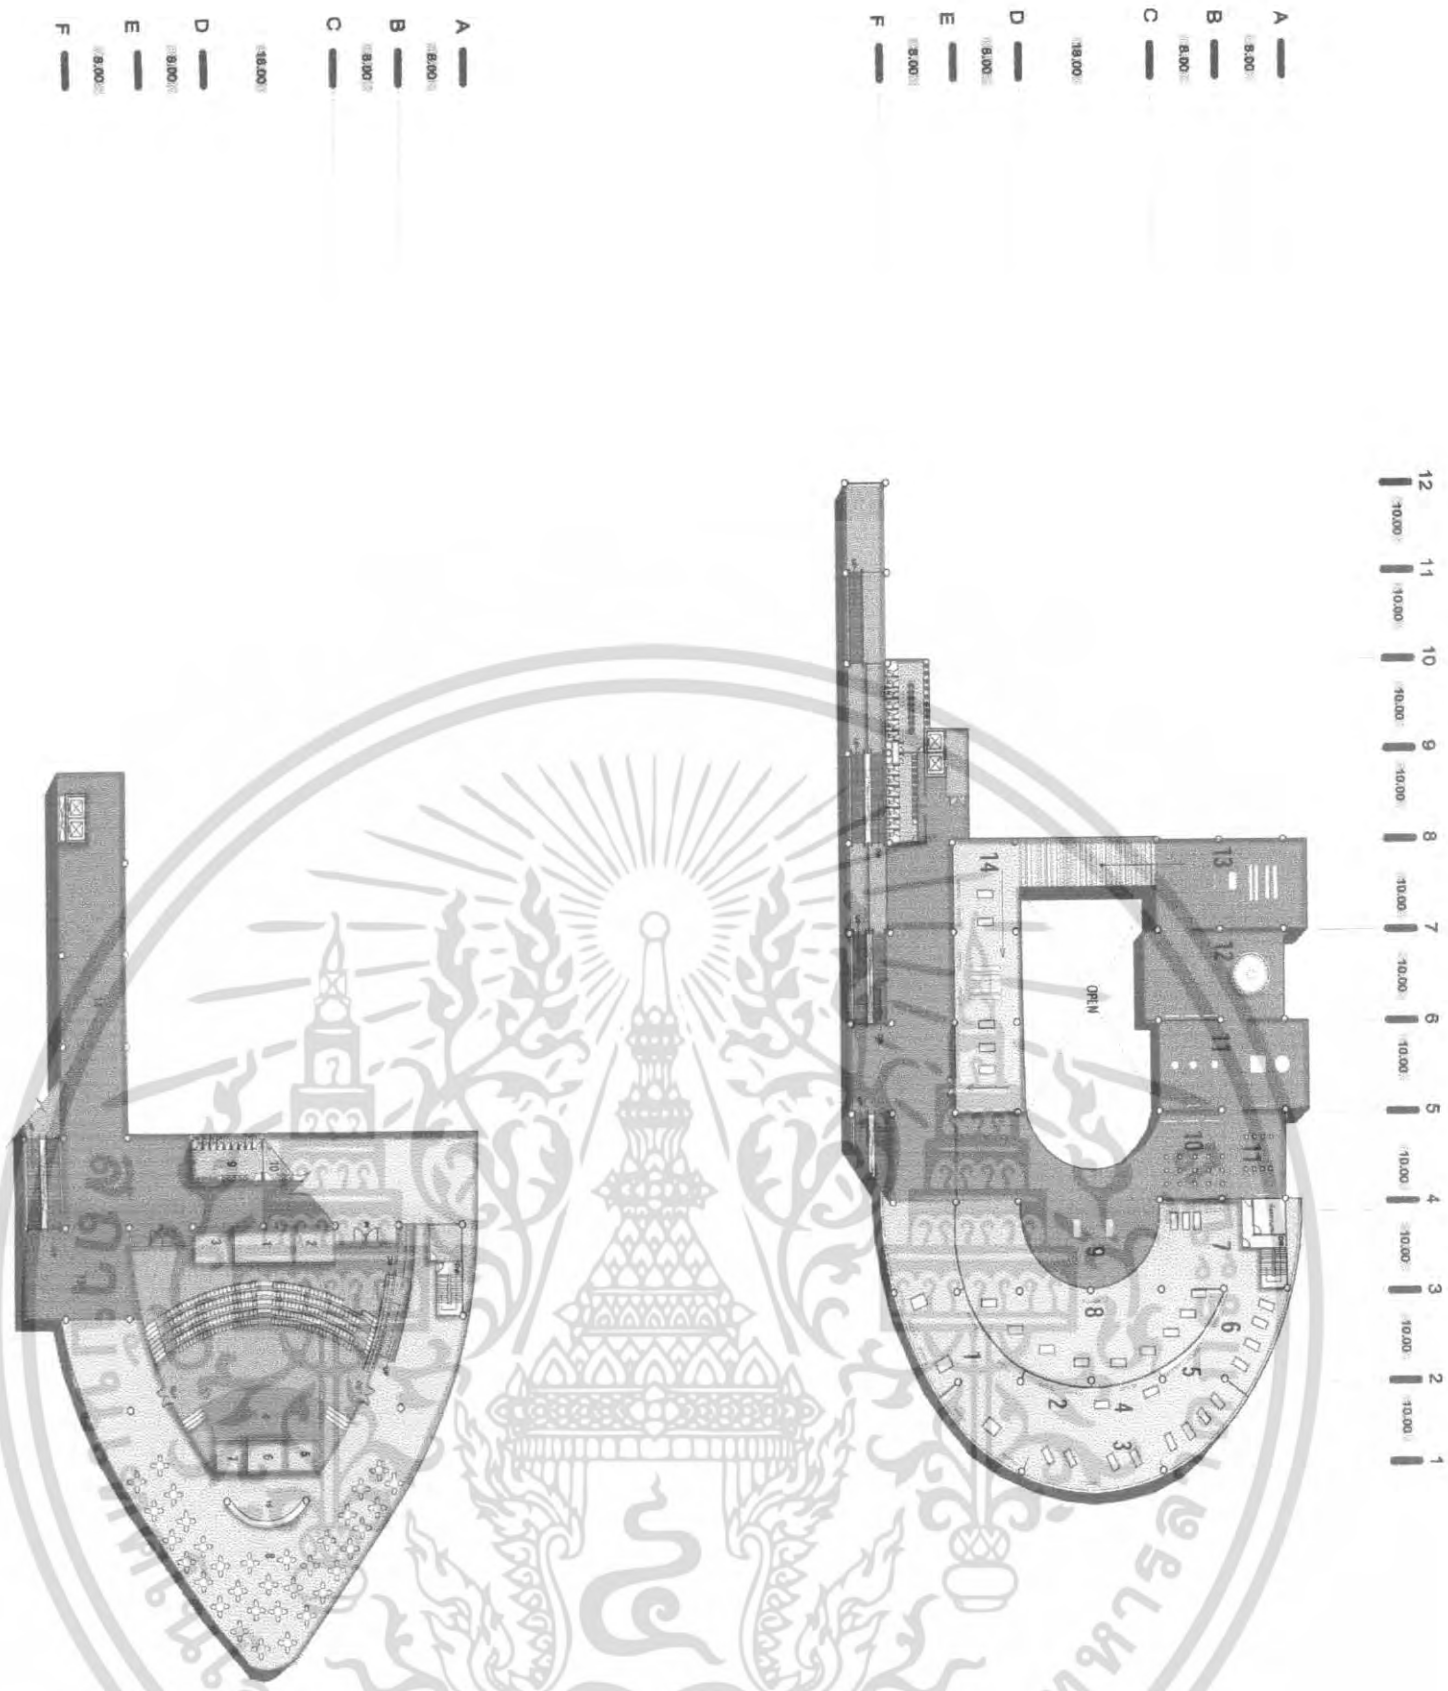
แสดงแบบ 3rd-4th floor plan
